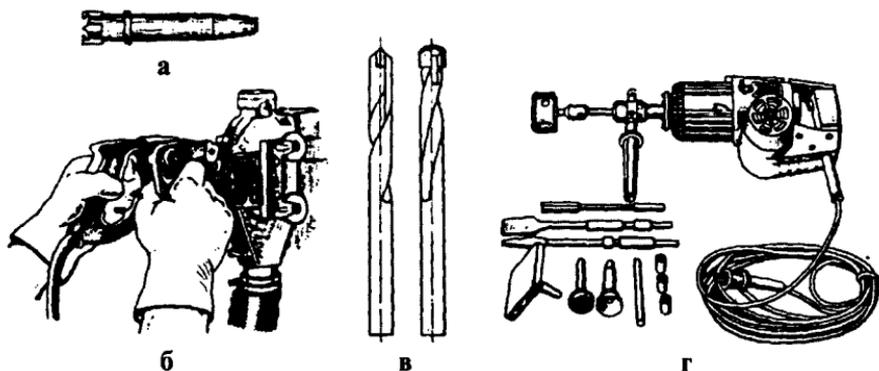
Инструмент, механизмы и приспособления для пробивных работ:
